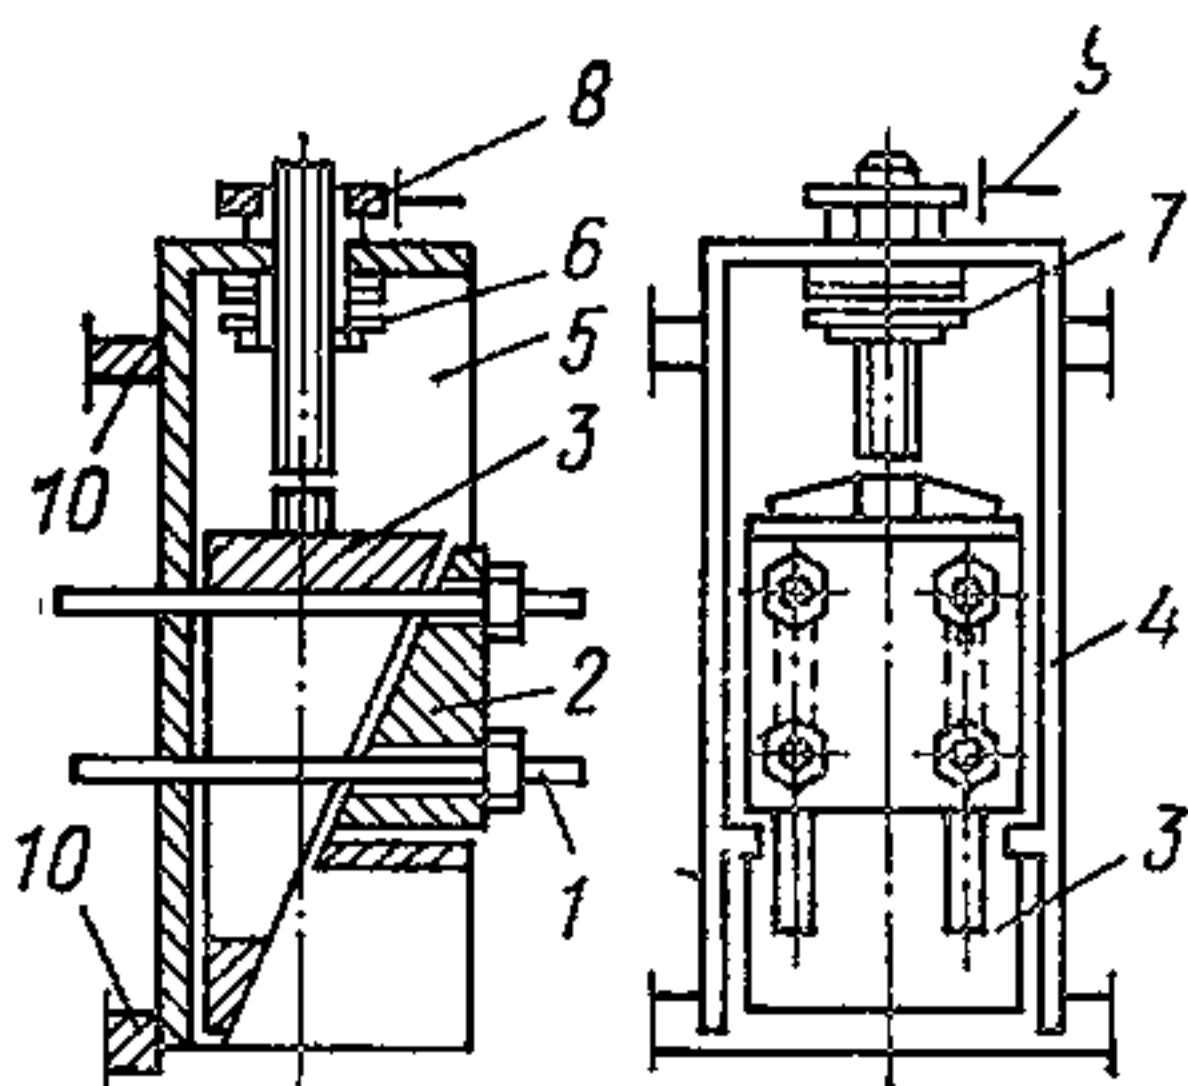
Клиновидное устройство для отпуска натяжения арматуры
